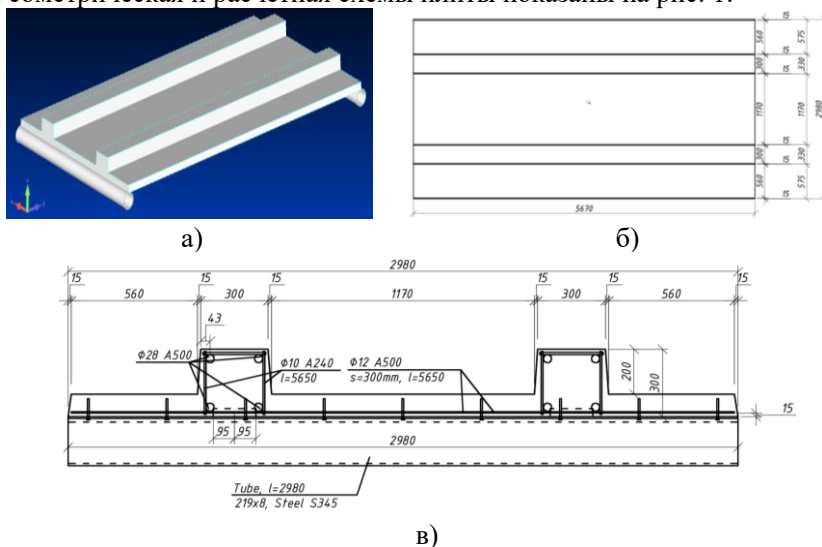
Плита покрытия заглубленного сооружения: а) твердотельная модель; б) план; в) поперечное сечение
